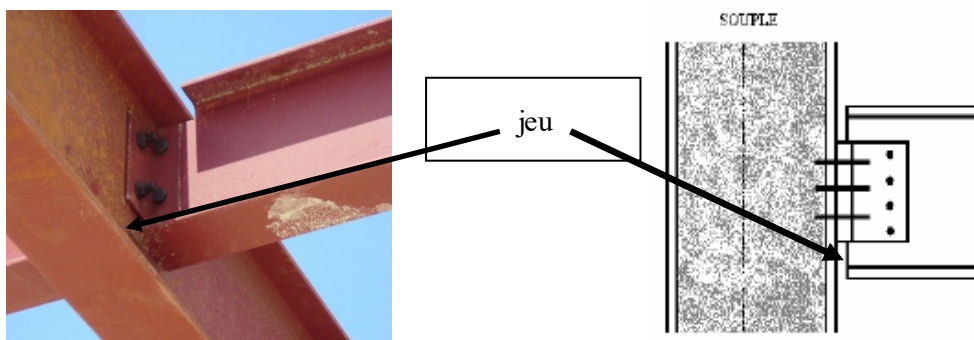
exemples de liaisons articulées par cornières (à gauche solive poutre principale et à droite poteau poutre)
